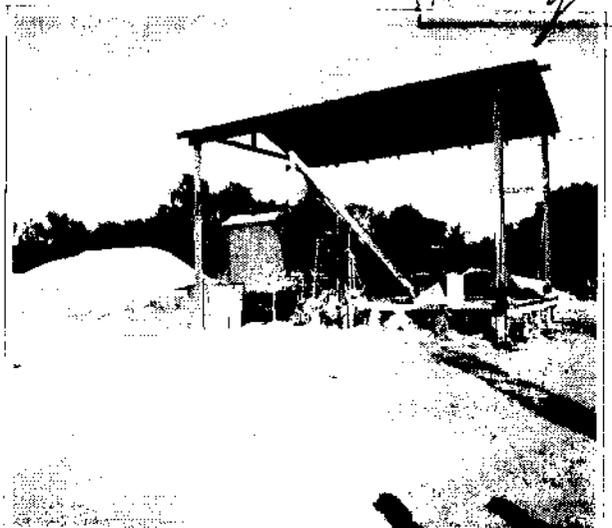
central de concreto e depósito ao fundo, na antiga área do canteiro
